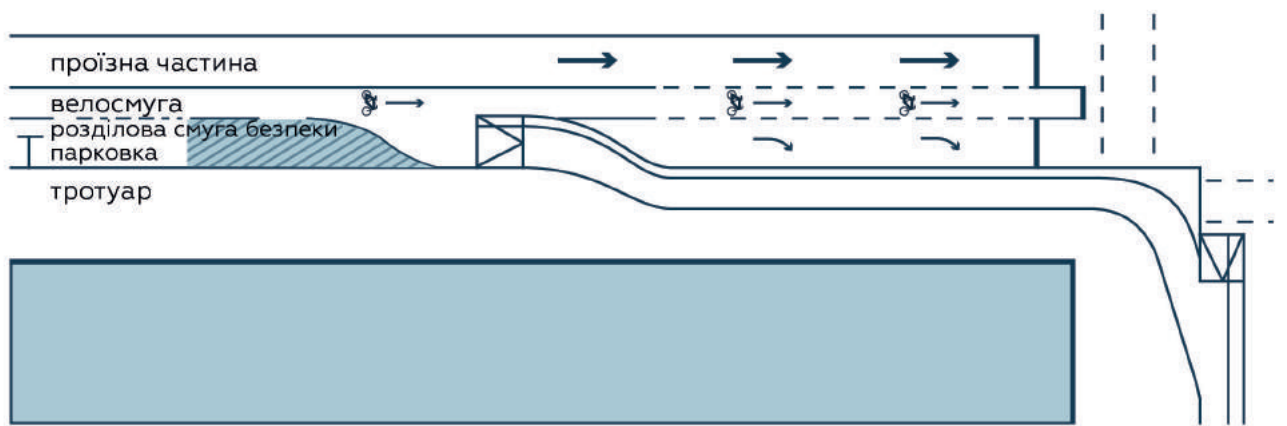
Велосипедна розвилка на початку правоповоротної смуги руху
